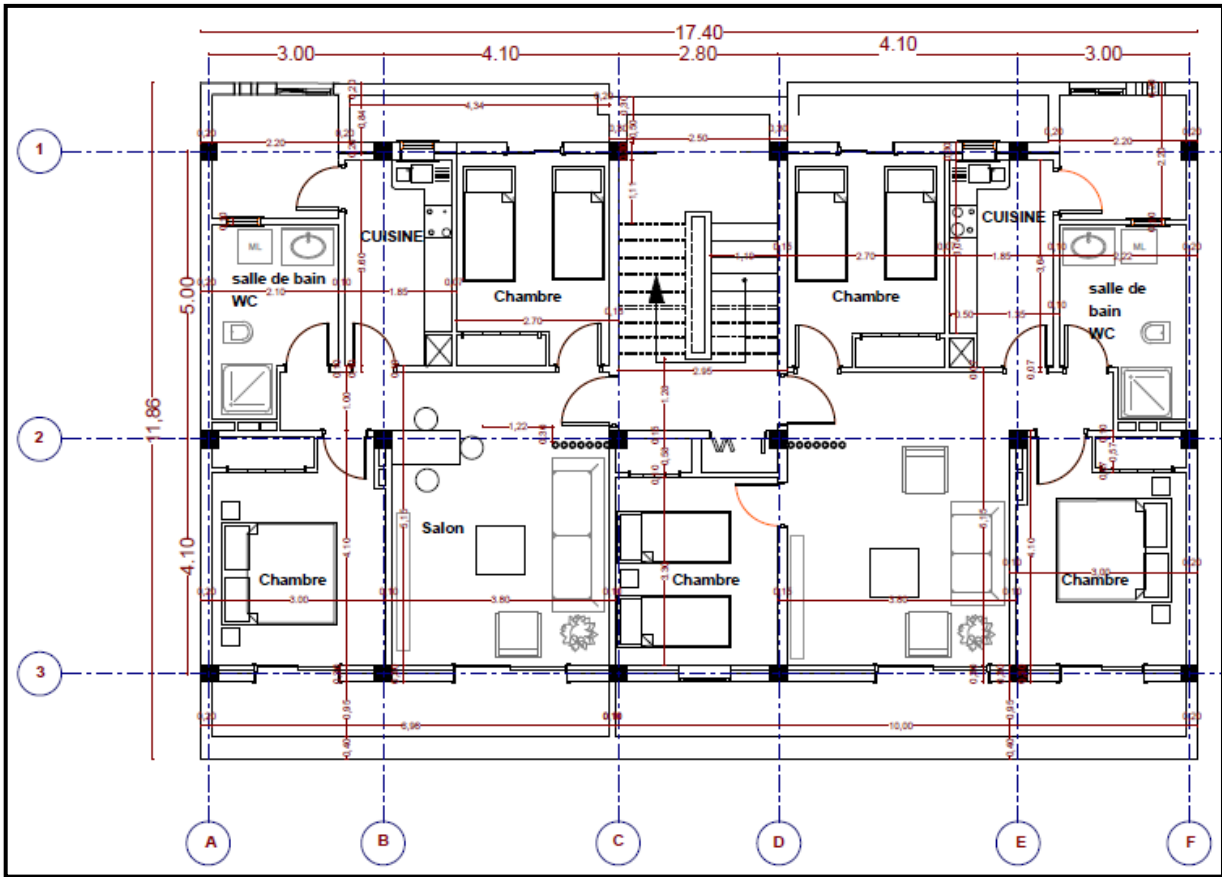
Plan de 3eme étage après la requalification. Source : auteur 2020
